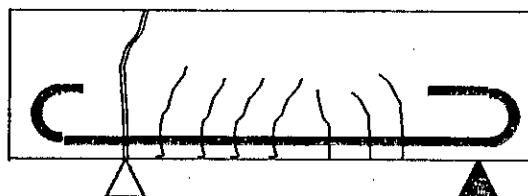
fissuration d'une poutre mince lors de la rupture par fendage
